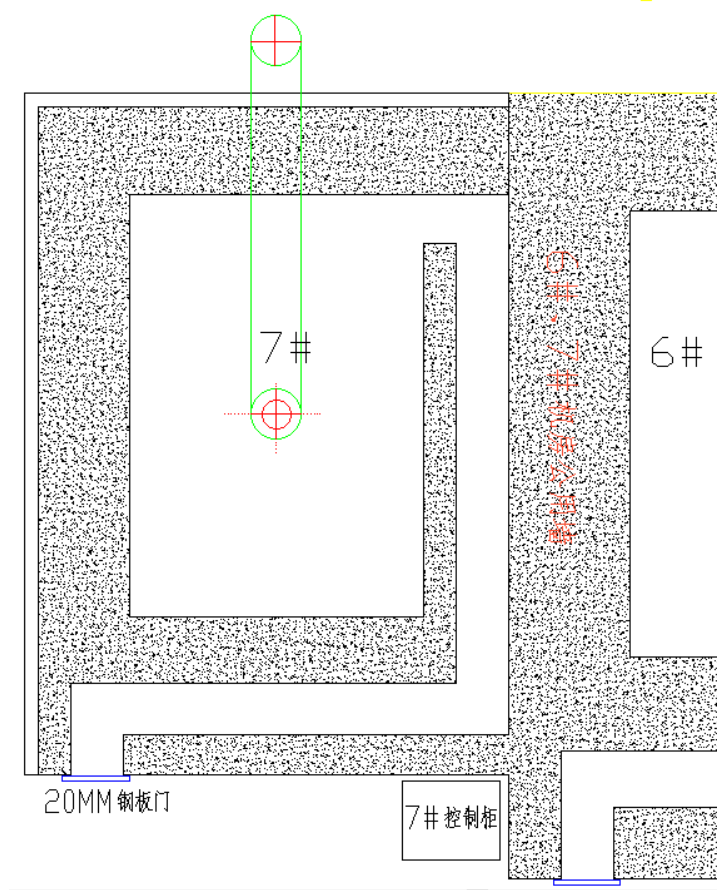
7#加速器机房通风管道布设示意图（平面图）
